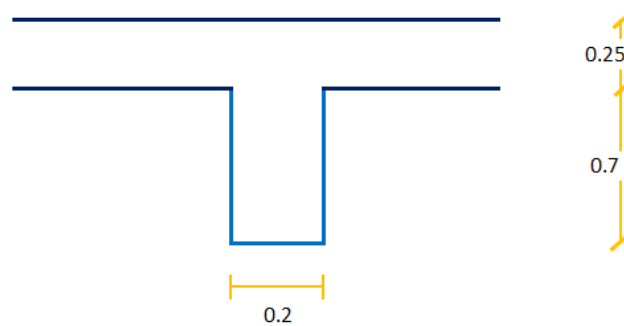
DETALLES DE CORTE-FUENTE: ELABORACION PROPIA
